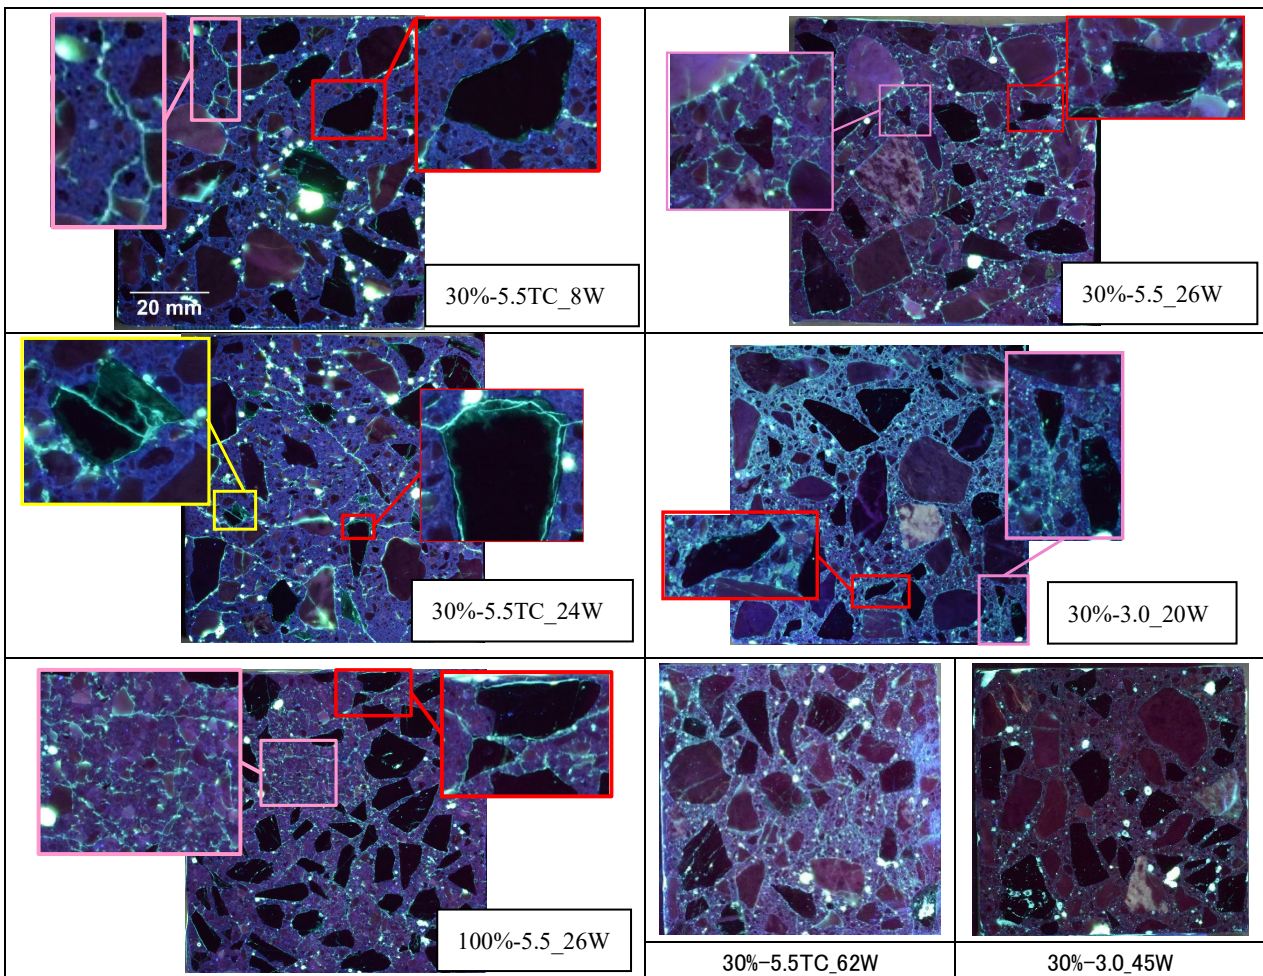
蛍光樹脂含浸による内部ひび割れ観察
